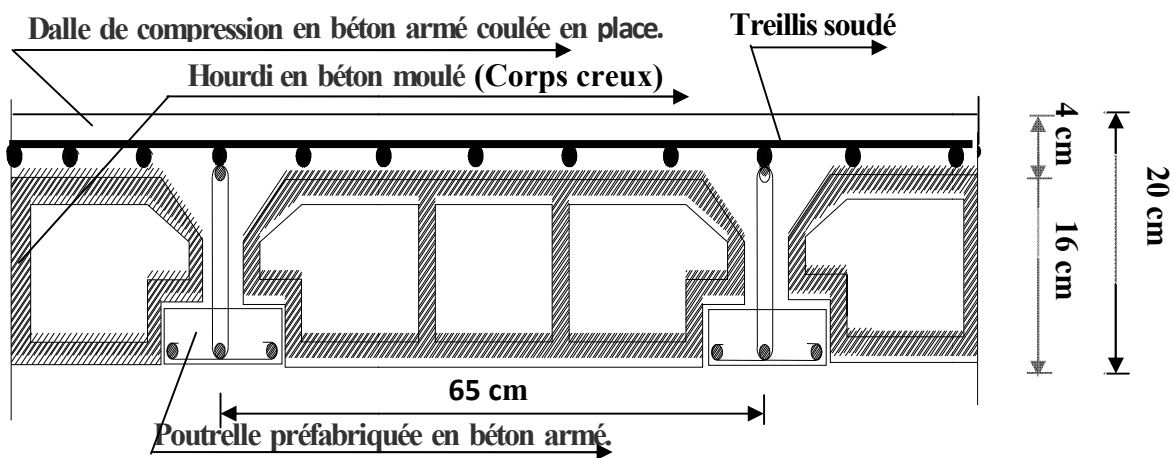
Coupe transversale d'un plancher en corps creux.
